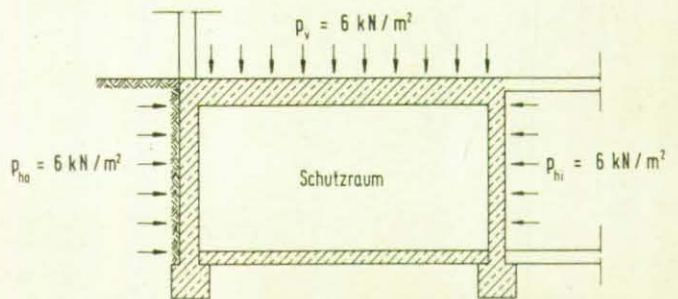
Anböschung horizontal bis Oberkante Stahlbetondecke bzw. Zementestrich oder 1 : 2 Anschüttung
